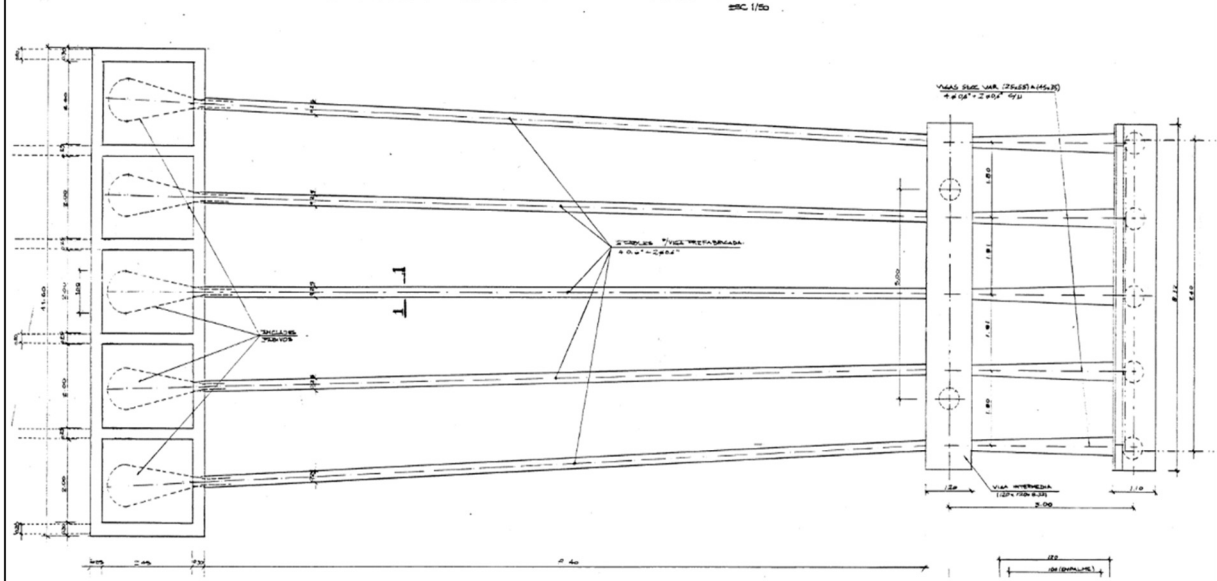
Detalle en planta del sistema de anclaje en los estribos de cabecera y macizo externo.
